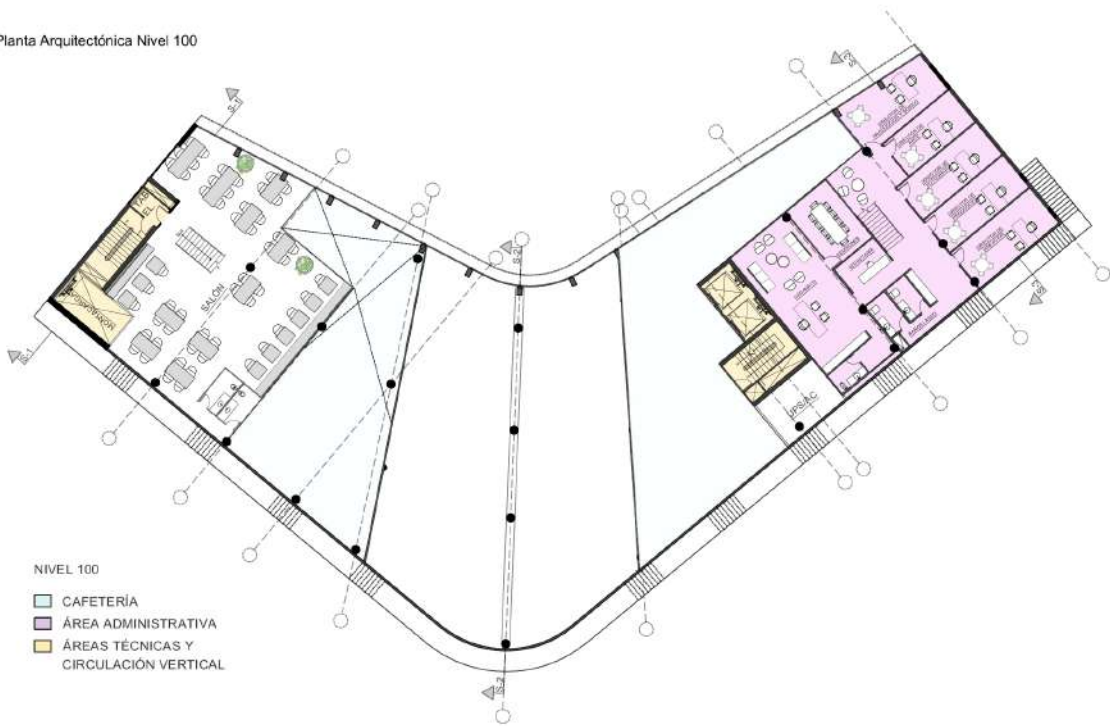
Planta Arquitectónica Nivel 100 / Escala 1:250
